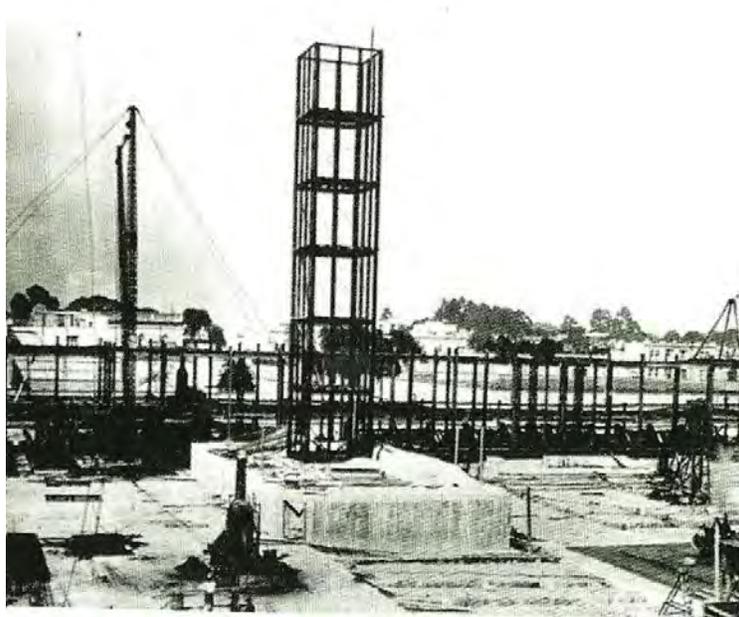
Uso de concreto en la cimentación del Palacio Legislativo (1905). En esta imagen se aprecian las vigas de que constituyen el esqueleto del edificio así como las cimentaciones realizadas con concreto.
